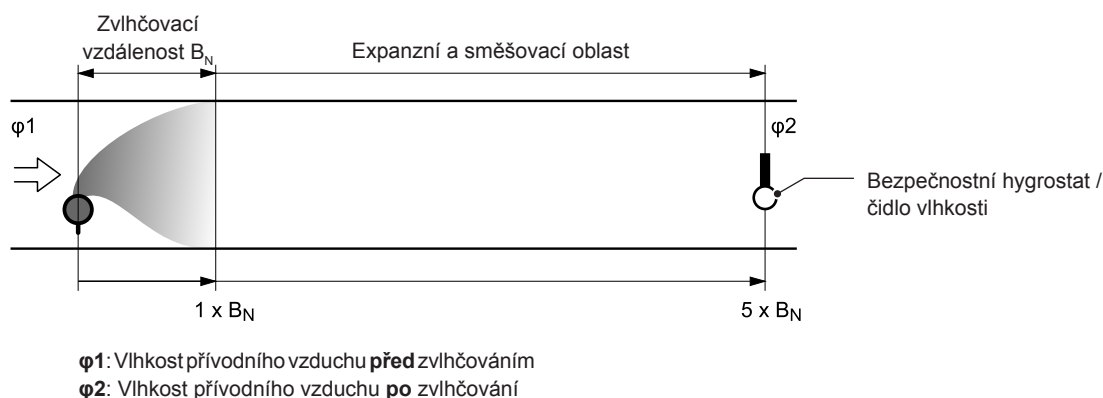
Přehled instalace parního systému prostorového zvlhčování
